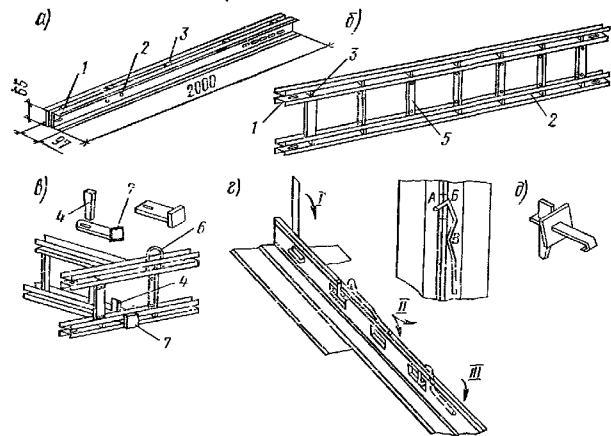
Несущие элементы разборно-переставной опалубки и их соединения: а — схватка; б — ферма; в — узлы соединения ферм; г — соединения щитов пружинными скобами; д — крош — с клином соединения щитов со схватками; 1 — отверстие под клин; 2 — отверстие под винтовые петли; 3 — прокладка; 4 — клин; 5 — съемные планки переменного размера; 6 — монтажная петля; 7 — Т-образная косынка; 8, 9, 10, 11 — последовательность операций по соединению щитов; А, Б, В — точки контакта скобы с ребрами щита
